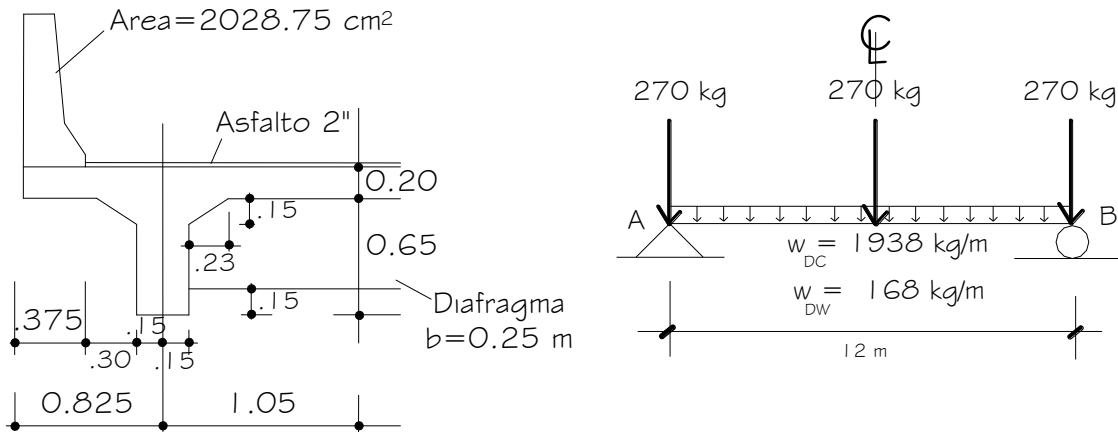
Cargas tipo DC aplicadas en la viga exterior
